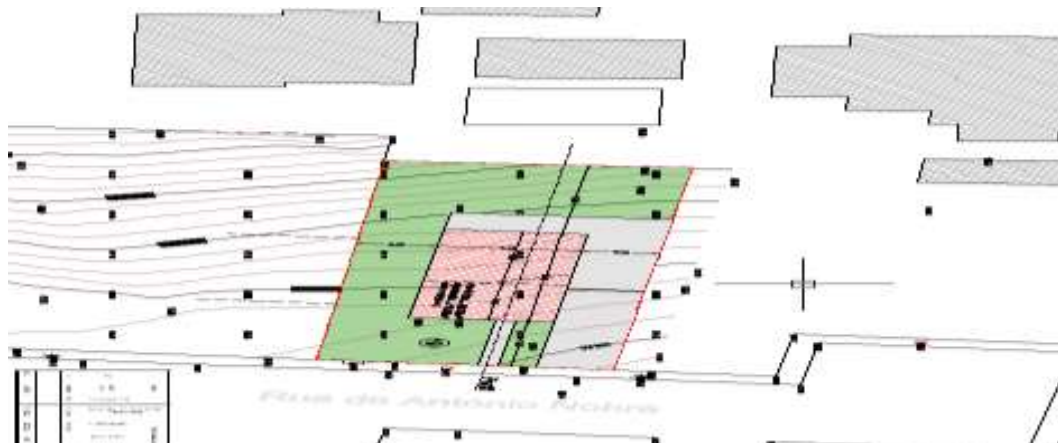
extrato da proposta de planta de implantação para o lote nº 19. -----
